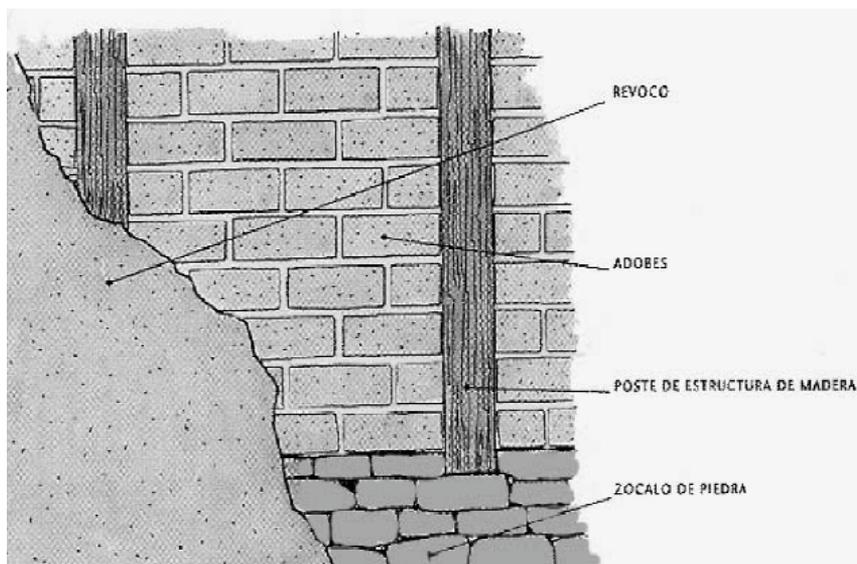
Esquema de la estructura de las paredes de las viviendas.
